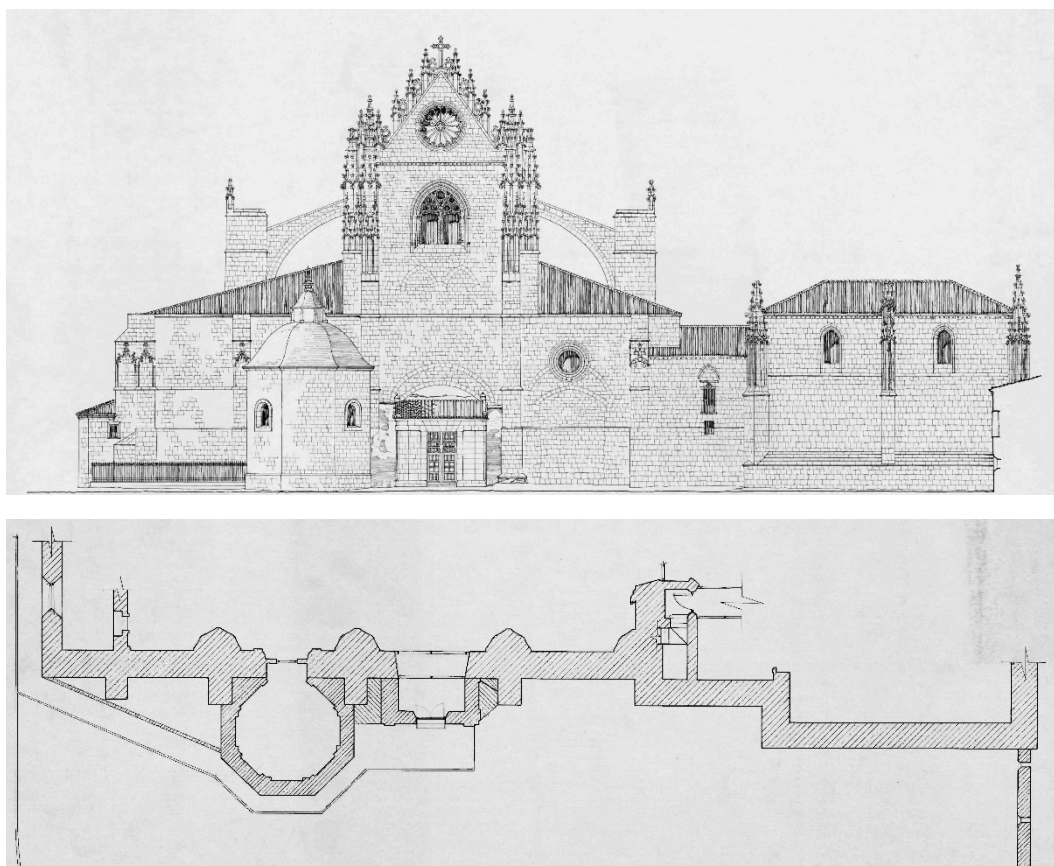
Alzado y planta de la fachada de la catedral de Palencia. *Ca.* 1977. Dibujos realizados con motivo de su restauración. IPCE, Planoteca.
